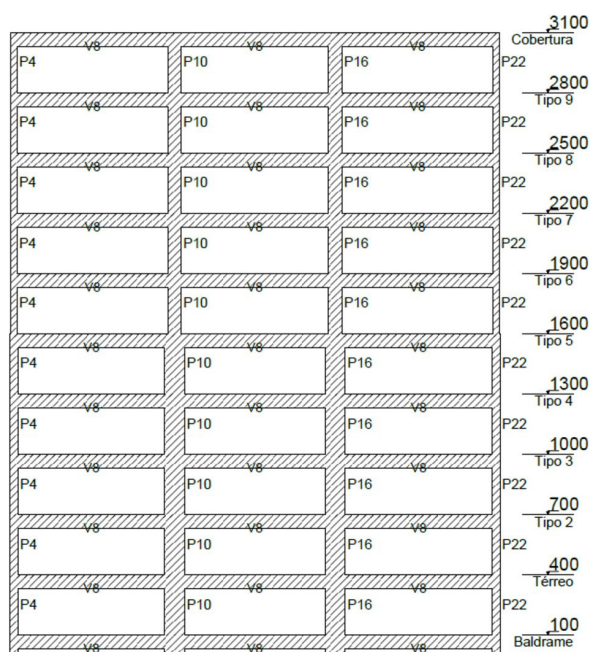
Corte esquemático do edifício de 10 pavimentos contraventado exclusivamente por pórticos.
